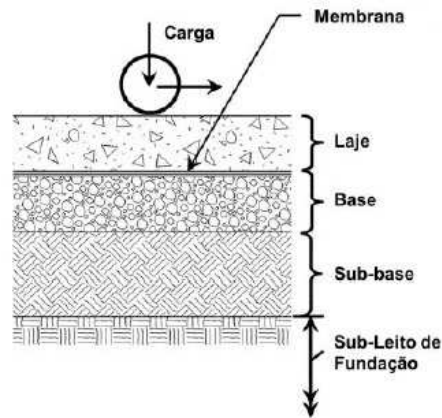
Estrutura de pavimentos industriais (adaptado de ACI Committee 360, 2010)
